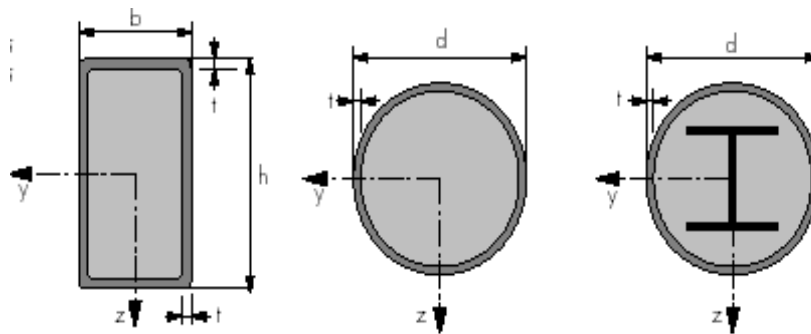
Exemples de poteaux mixtes remplis de béton.
